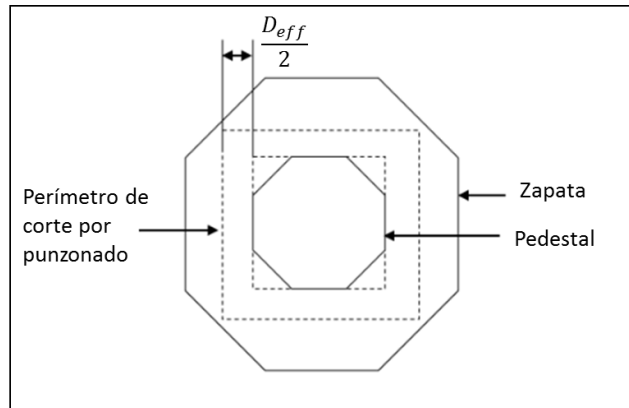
Vista de planta de la fundación. Fuente: STAAD Foundation Advanced.
